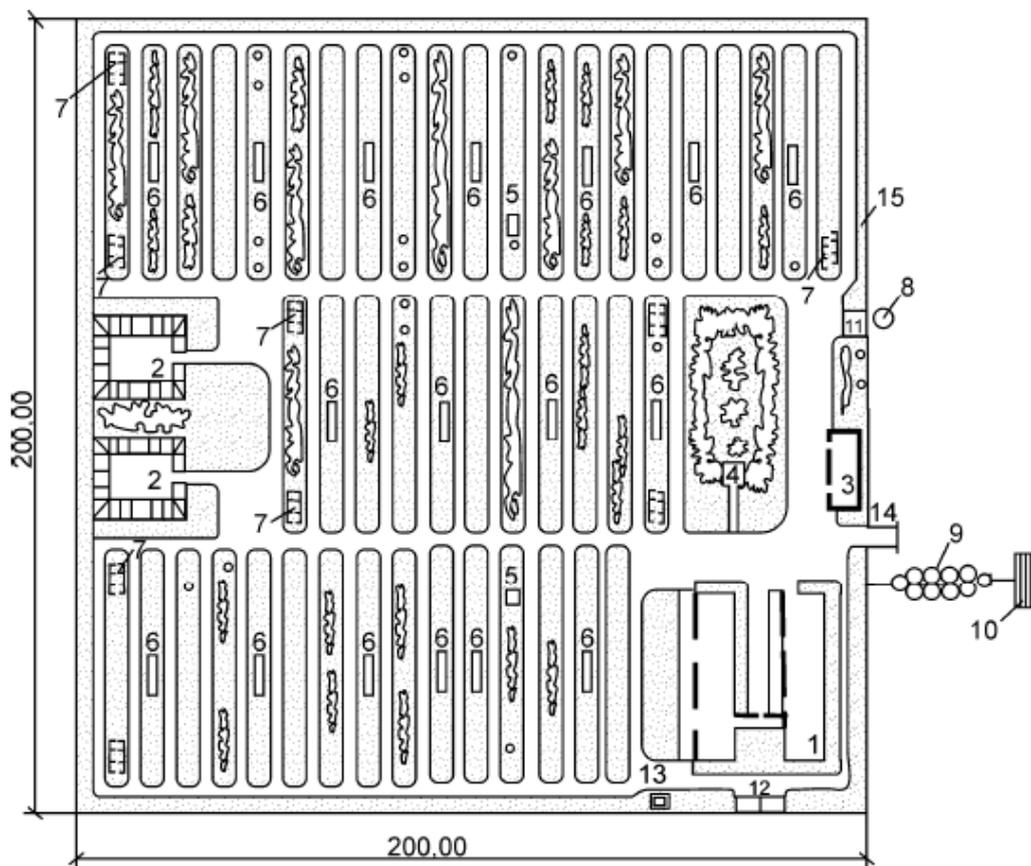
Схема генерального плана пчеловодческой фермы на 4 800 пчелиных семей: 1 – производственный корпус с сотохранилищем фермы на 4 800 пчелиных семей; 2 – зимовник на 1 200 пчелиных семей; 3 – склад для хранения лесохозяйственного инвентаря; 4 – беседка; 5 – теневой навес; 6 – поилка для пчел; 7 – улей однокорпусный с двумя магазинами; 8 – жижеборборник на 5 м³; 9 – септик; 10 – поля подземной фильтрации; 11 – площадка для обработки пчеловодного оборудования и инвентаря; 12 – площадка для угля и золы; 13 – трансформаторная подстанция; 14 – ворота; 15 – ограждение из металлической сетки по железобетонным столбам
